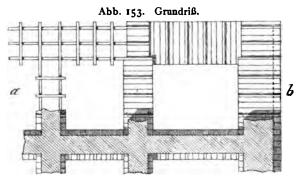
u. 153. Pfahlrost für ein rechteckiges Gebäude.
